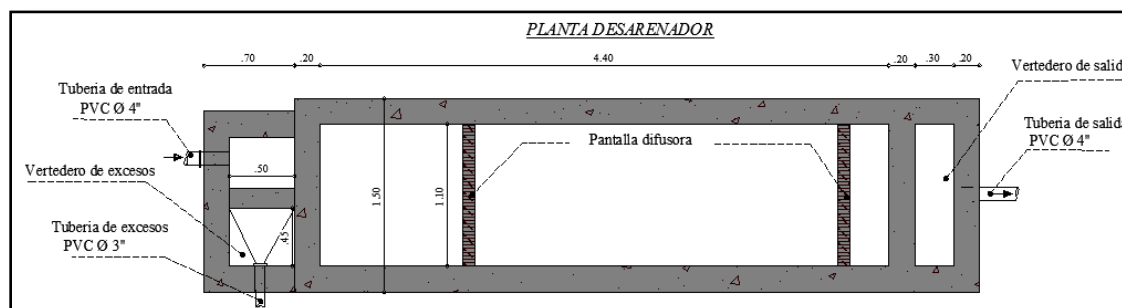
Plano en planta de desarenador diseñado. Fuente: Autores del proyecto.
